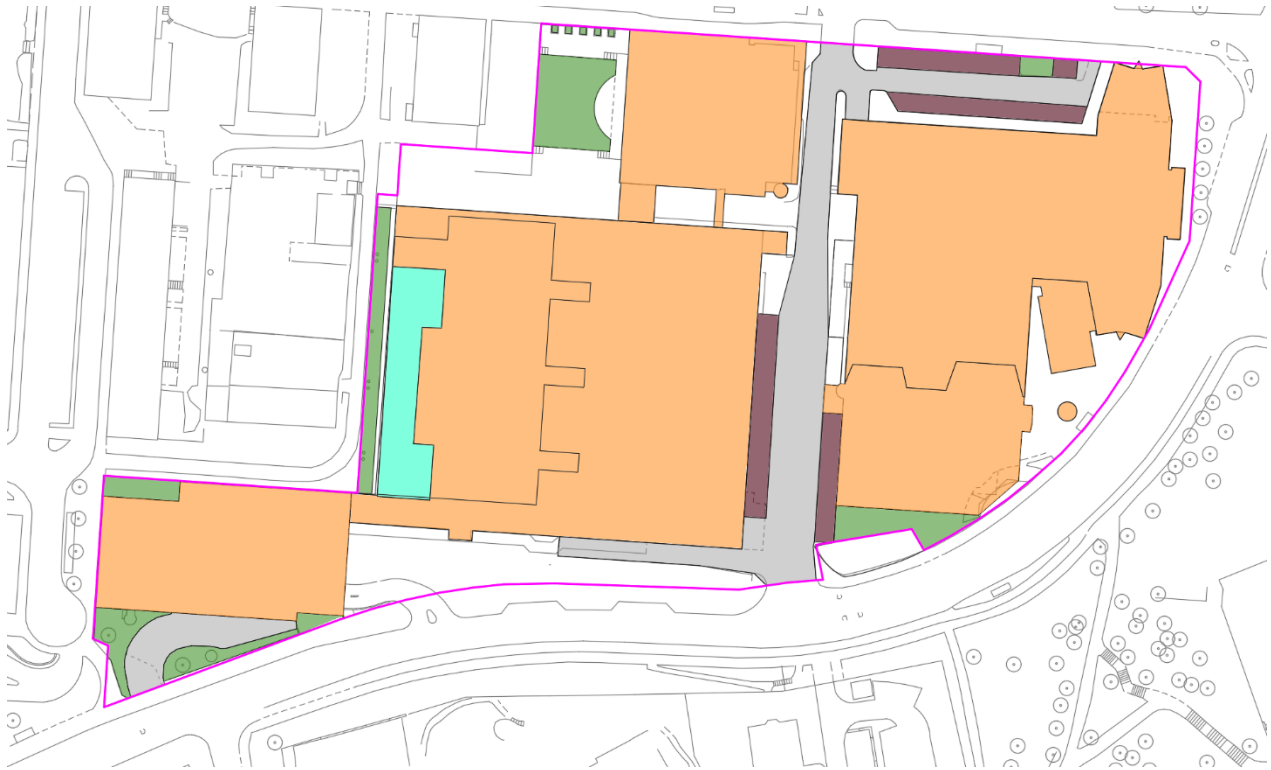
Situationsplan Lanskapslaget AB (2025-05-20)
